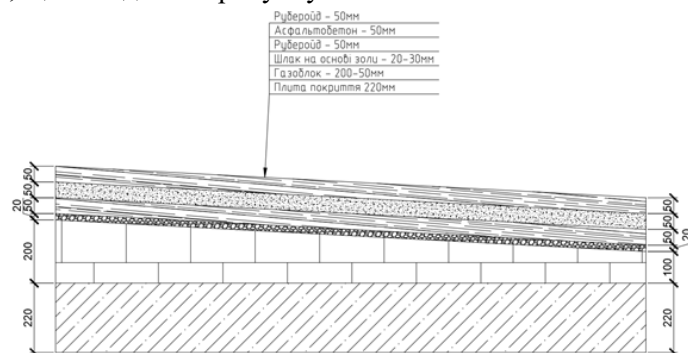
Конструкція існуючого покриття будівлі для якої проводилося обстеження
